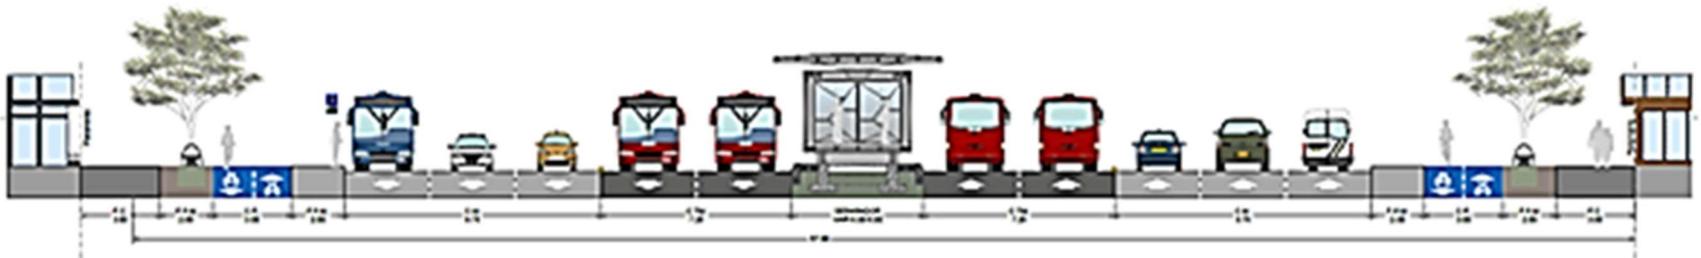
Sección vial con estaciones Av. Calle 66A – Av. Calle 80
